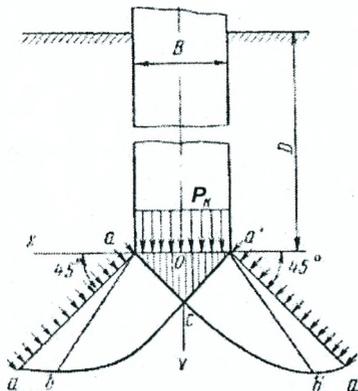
Схема для определения предельного давления на основании фундамента глубокого заложения, предварительно неуплотненное
